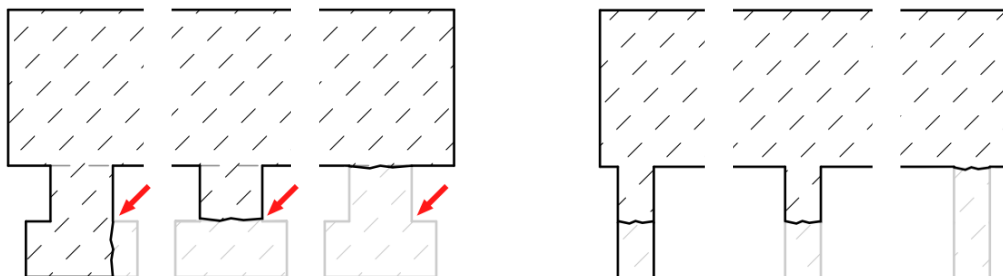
Längsschnitt (li) und Querschnitt (re) des Versagens unter Querlast durch den Verbindungspartner Schlaufenkomponente und Betonbruch in Form eines Betonausbruchkegels (jeweils li) oder an einer geometrisch oder materialspezifisch bedingten Schwachstelle (jeweils m und re)
